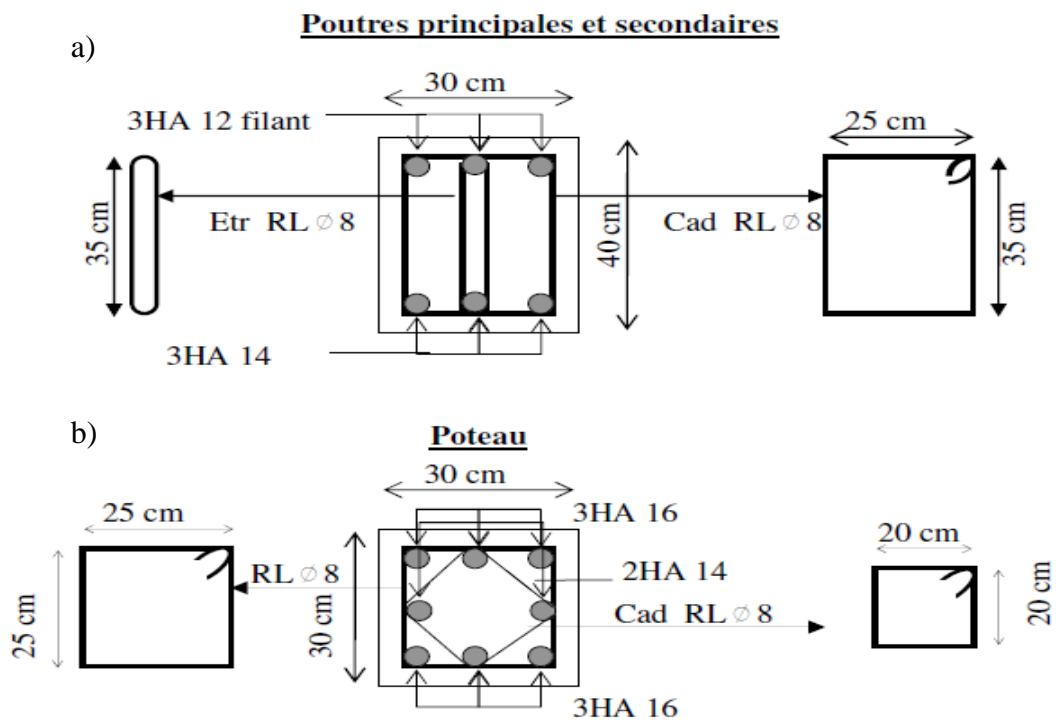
Schéma de ferrailage des éléments structurelles a) poutre principales et secondaires - b) poteau.
